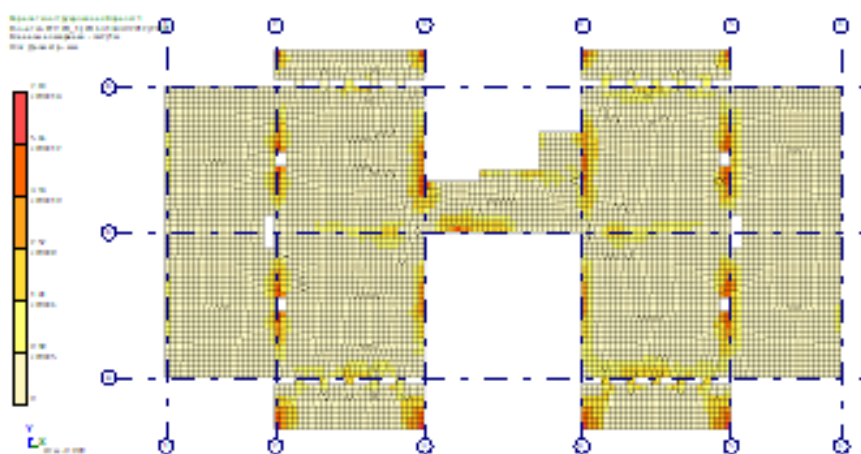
Площадь полной арматуры на 1мм по оси X у верхней грани перекрытия на отм. 0.000
